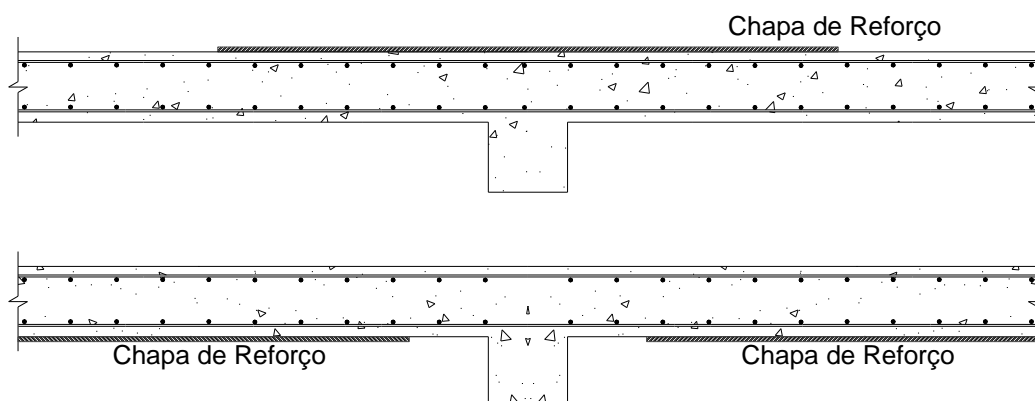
Esquema tipo de reforço de lajes com chapas metálicas coladas.
